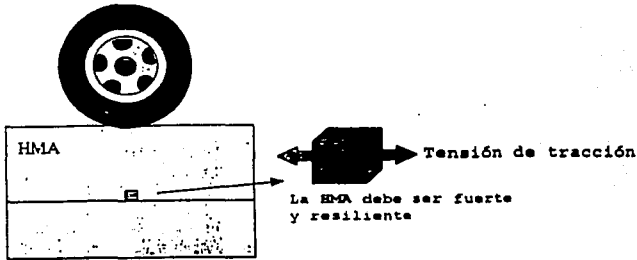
13 TENSIONES DE TRACCIÓN EN LA PARTE INFERIOR DE LA CAPA DE HMA.
